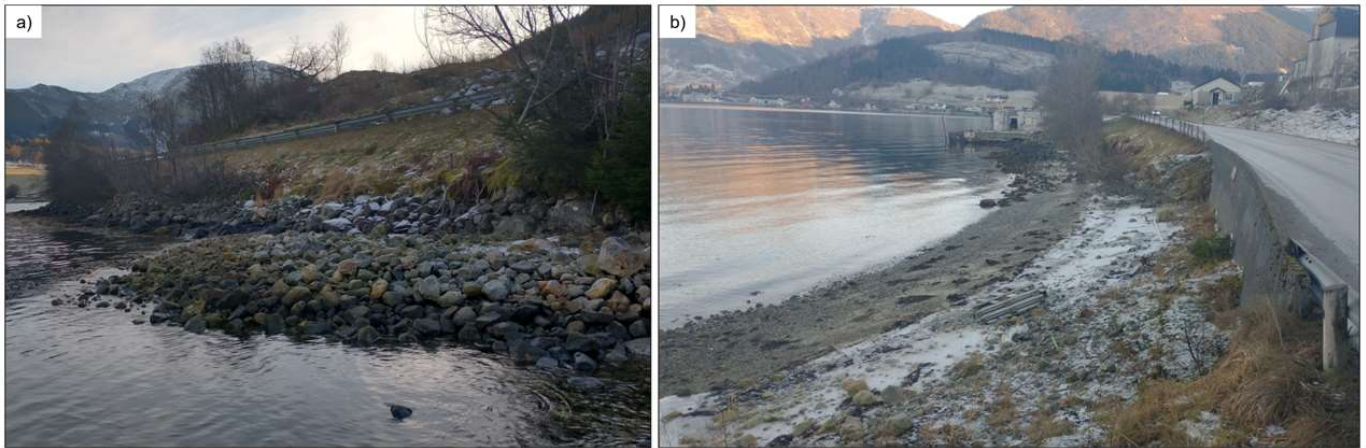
Bildet er tatt hvor Oksareelva føres under Omvikdalsvegen ved kulvert med dimensjon 5 x 2.5 meter. Dimensjonering er tilstrekkelig til å ta unna flomverdier langt over Q200 flomverdier.
